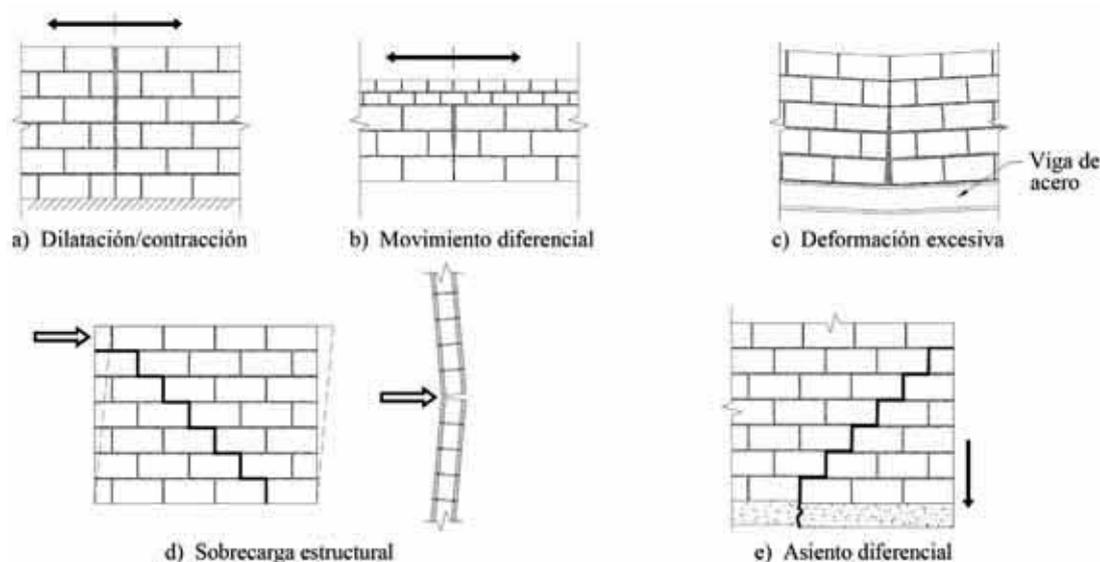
Causas de fisuración de la fábrica.
